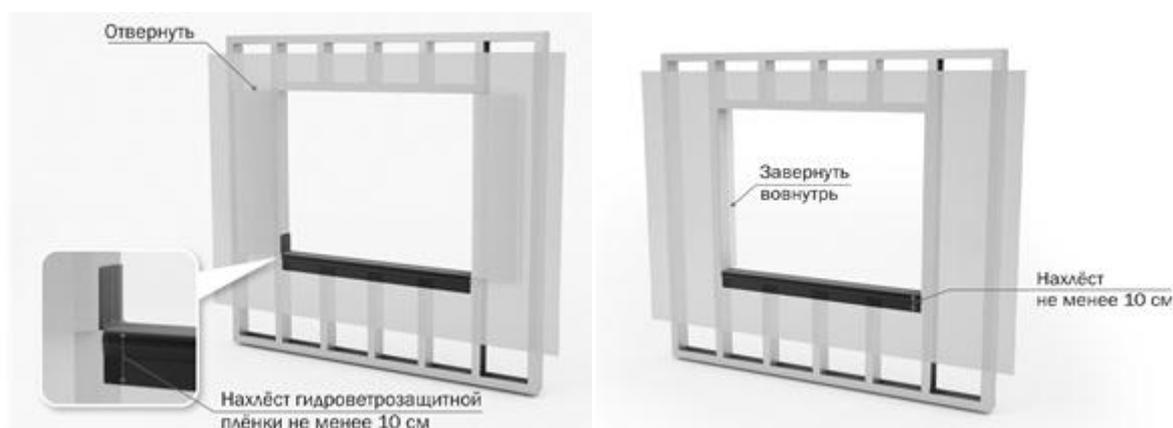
Монтаж гидроветрозащитной пленки
